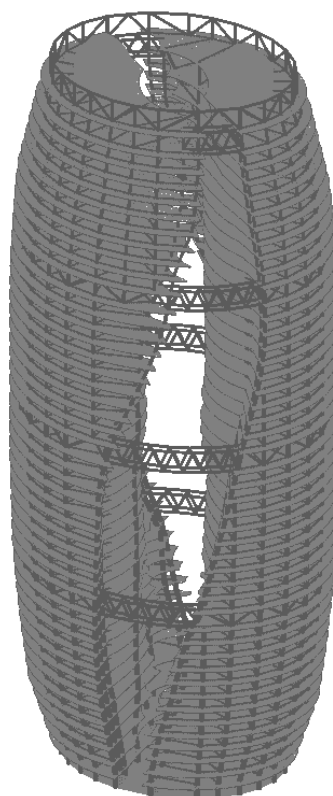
Расчетная схема здания в ПК SCAD
